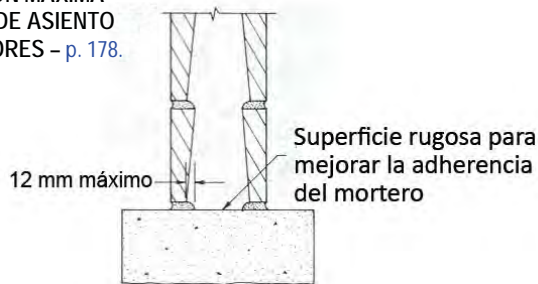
JUNTA DE MORTERO EN DESPLANTE DE MURO - p. 97.
